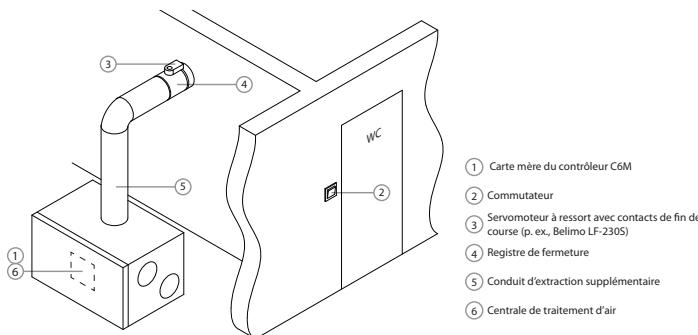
Exemple de montage d'un conduit d'extraction d'air supplémentaire
